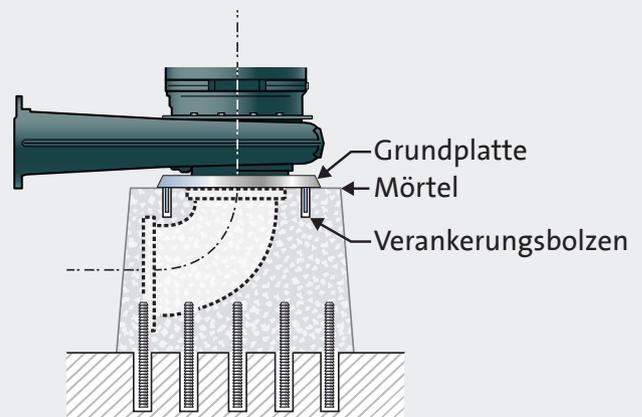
Fundament mit Grundplatte, Verankerungsbolzen und Mörtel zwischen Fundament und Grundplatte.
